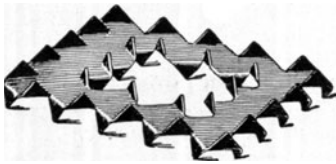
Bulldogplatte. Sie wird zwischen die Holzteile gelegt; die Zähne dringen beim Zusammenpressen der Hölzer durch Anziehen der Bolzen in das Holz. Für das Zusammenpressen sind besondere Vorkehrungen nötig.
